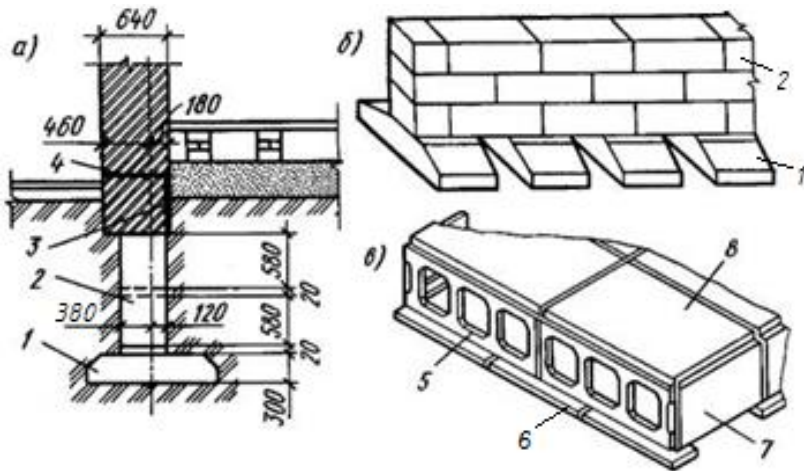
Полегшені залізобетонні фундаменти: а – зменшеної товщини; б – переривчасті; в – з цокольних панелей; 1 – фундаментна блок-подушка; 2 – блоки фундаментної стіни; 3 – обмазка гарячим бітумом; 4 – горизонтальна гідроізоляція; 5 – цокольна ферма-панель; 6 – фундаментна плита; 7 – цокольна панель; 8 – плита перекриття
